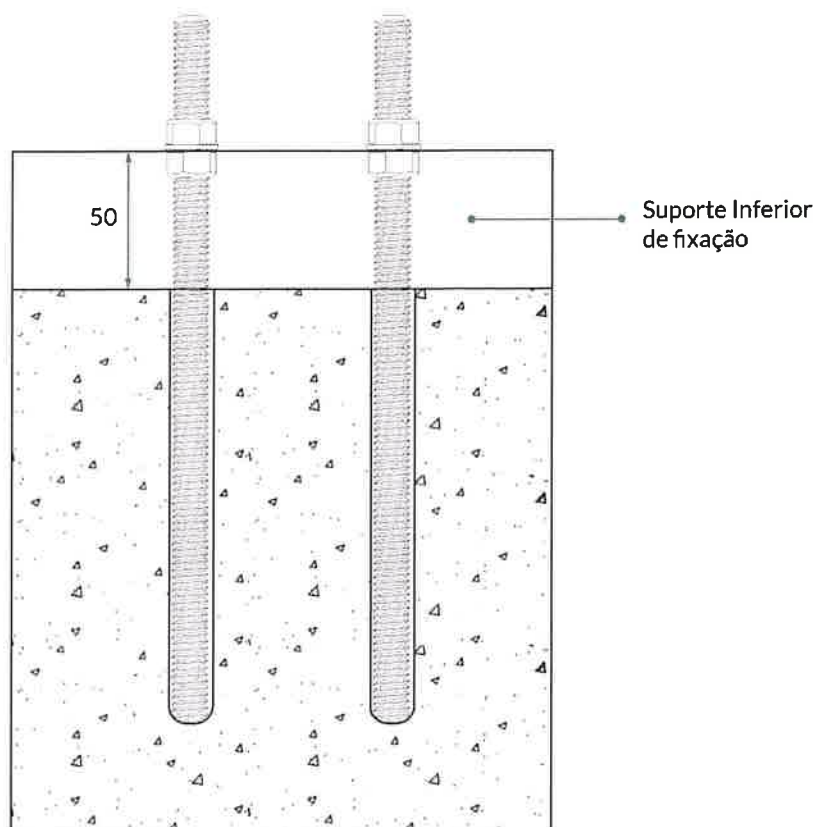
Montagem do roscado com o suporte inferior de fixação.
